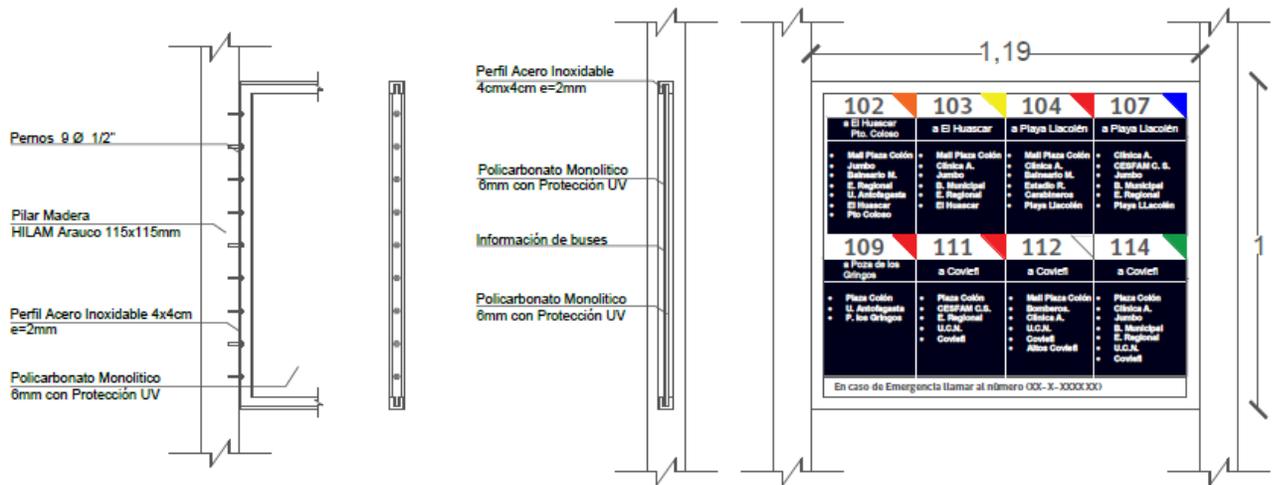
Detalles de unión pilar-pared posterior y pilar-panel informativo
